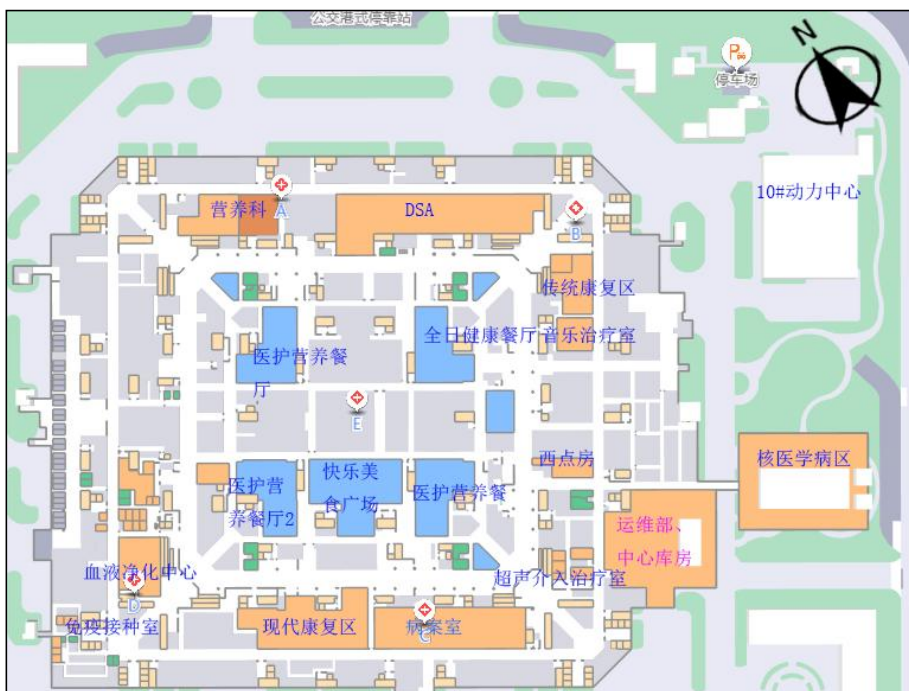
西安国际医学中心医院主楼地下一层平面布置图
